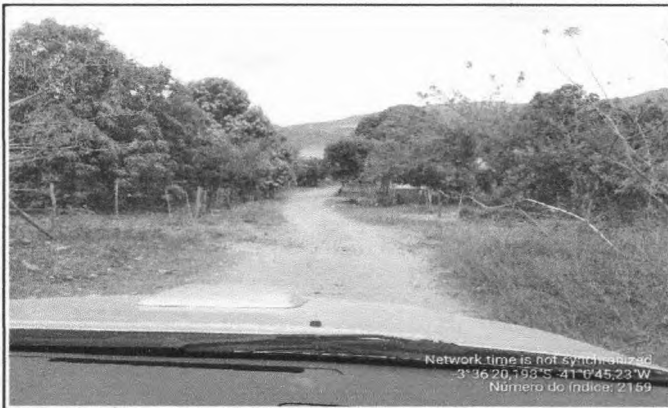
LOCAL DA CONSTRUÇÃO - BUEIRO TRIPLO TUBULAR
